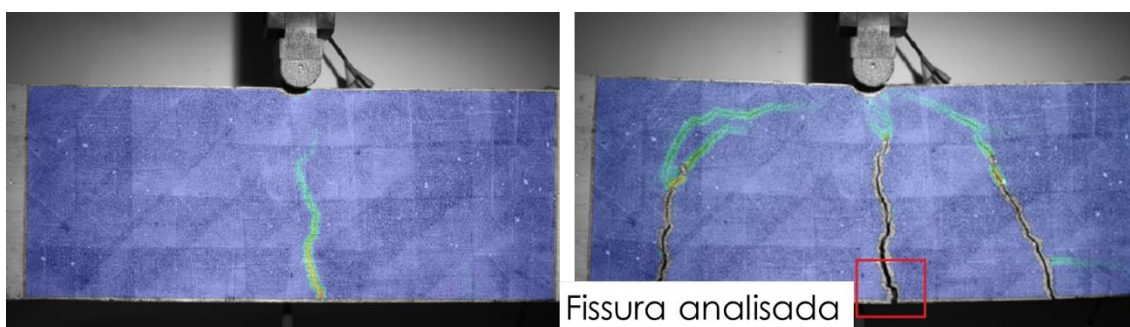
Viga V2-REF - Início da fissuração e na ruptura
